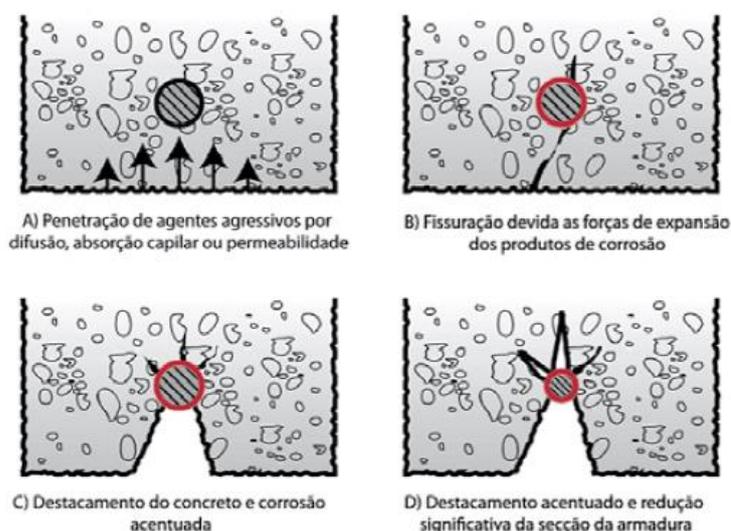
Evolução esquemática da deterioração de estruturas de concreto por corrosão de armaduras
